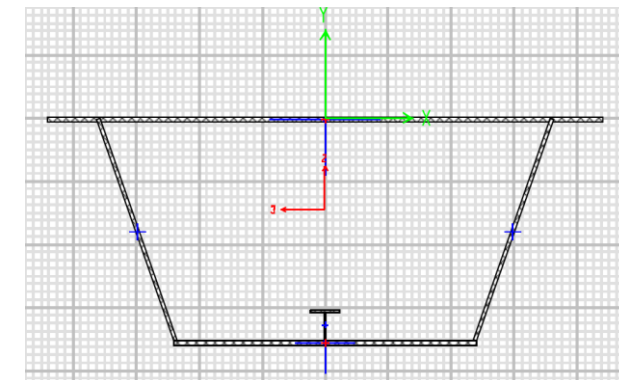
Geometría de sección transversal cajón del tablero, considerada en el modelo de cálculo (Section Designer)
